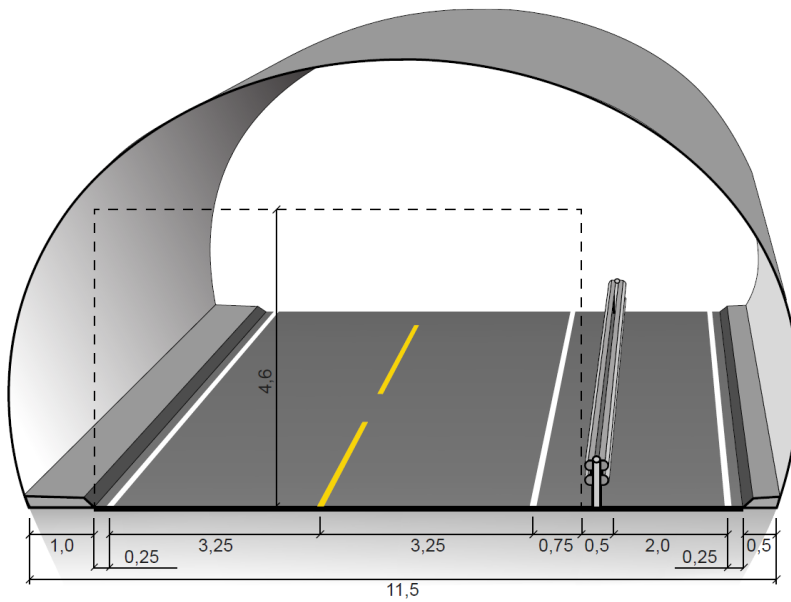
Tunnelprofil T12,5 med havarinisje (mål i m)
